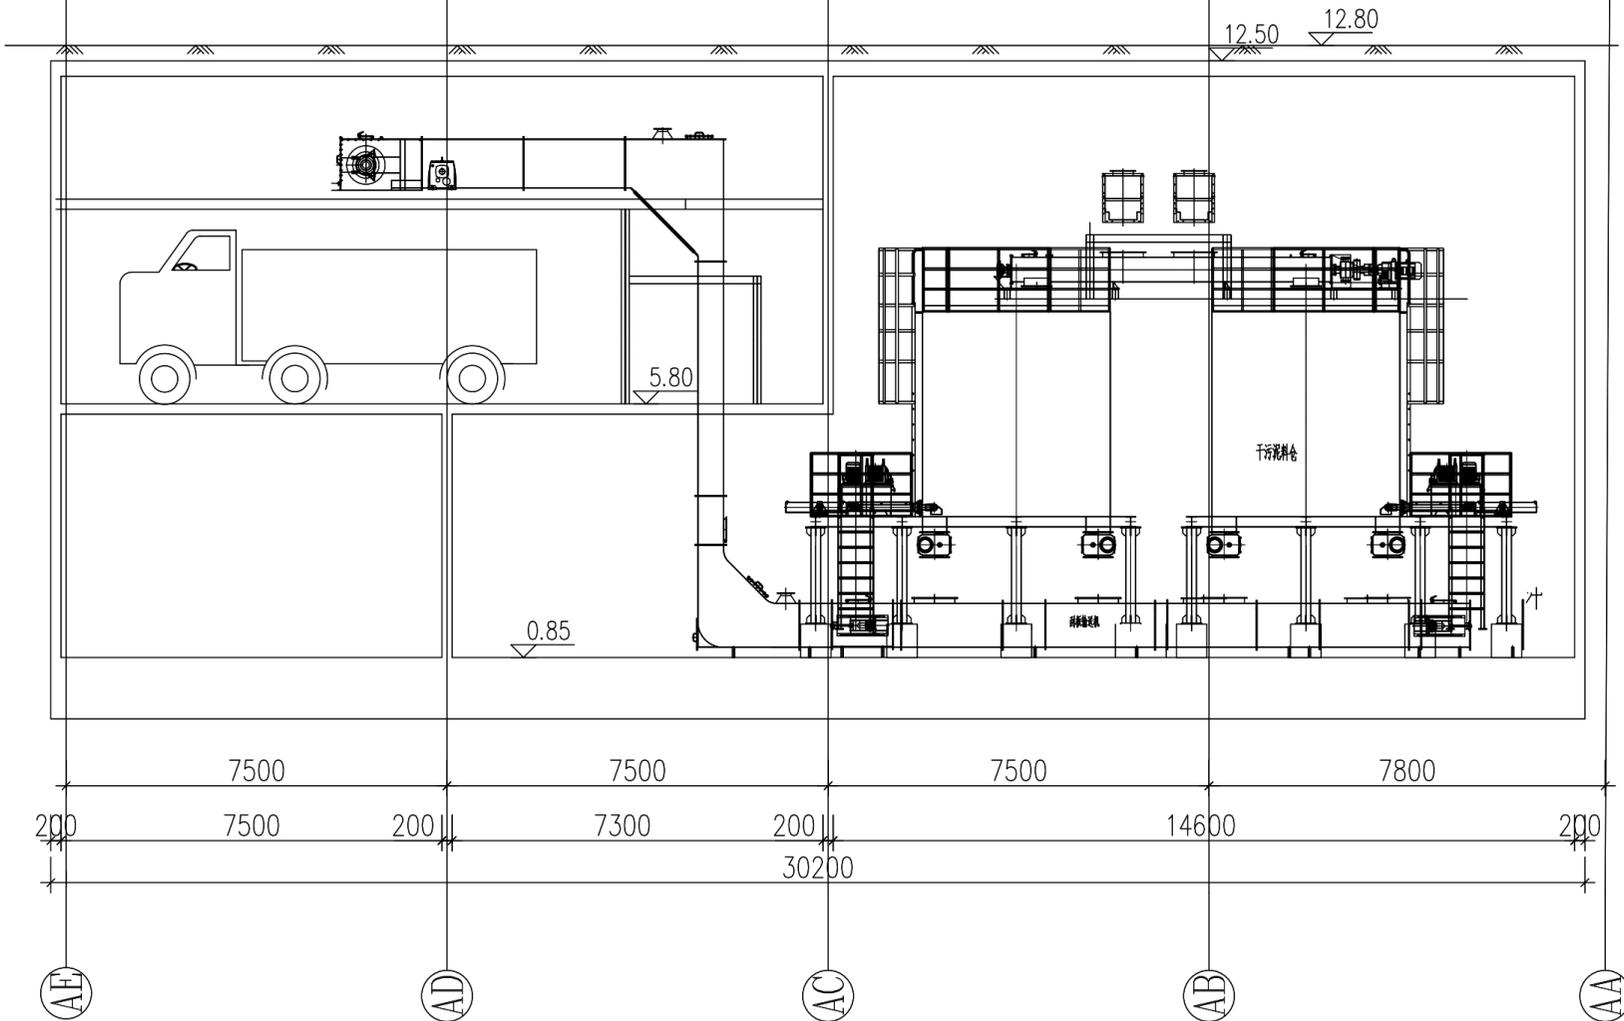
污泥脱水车间剖面图 (B-B 断面)
